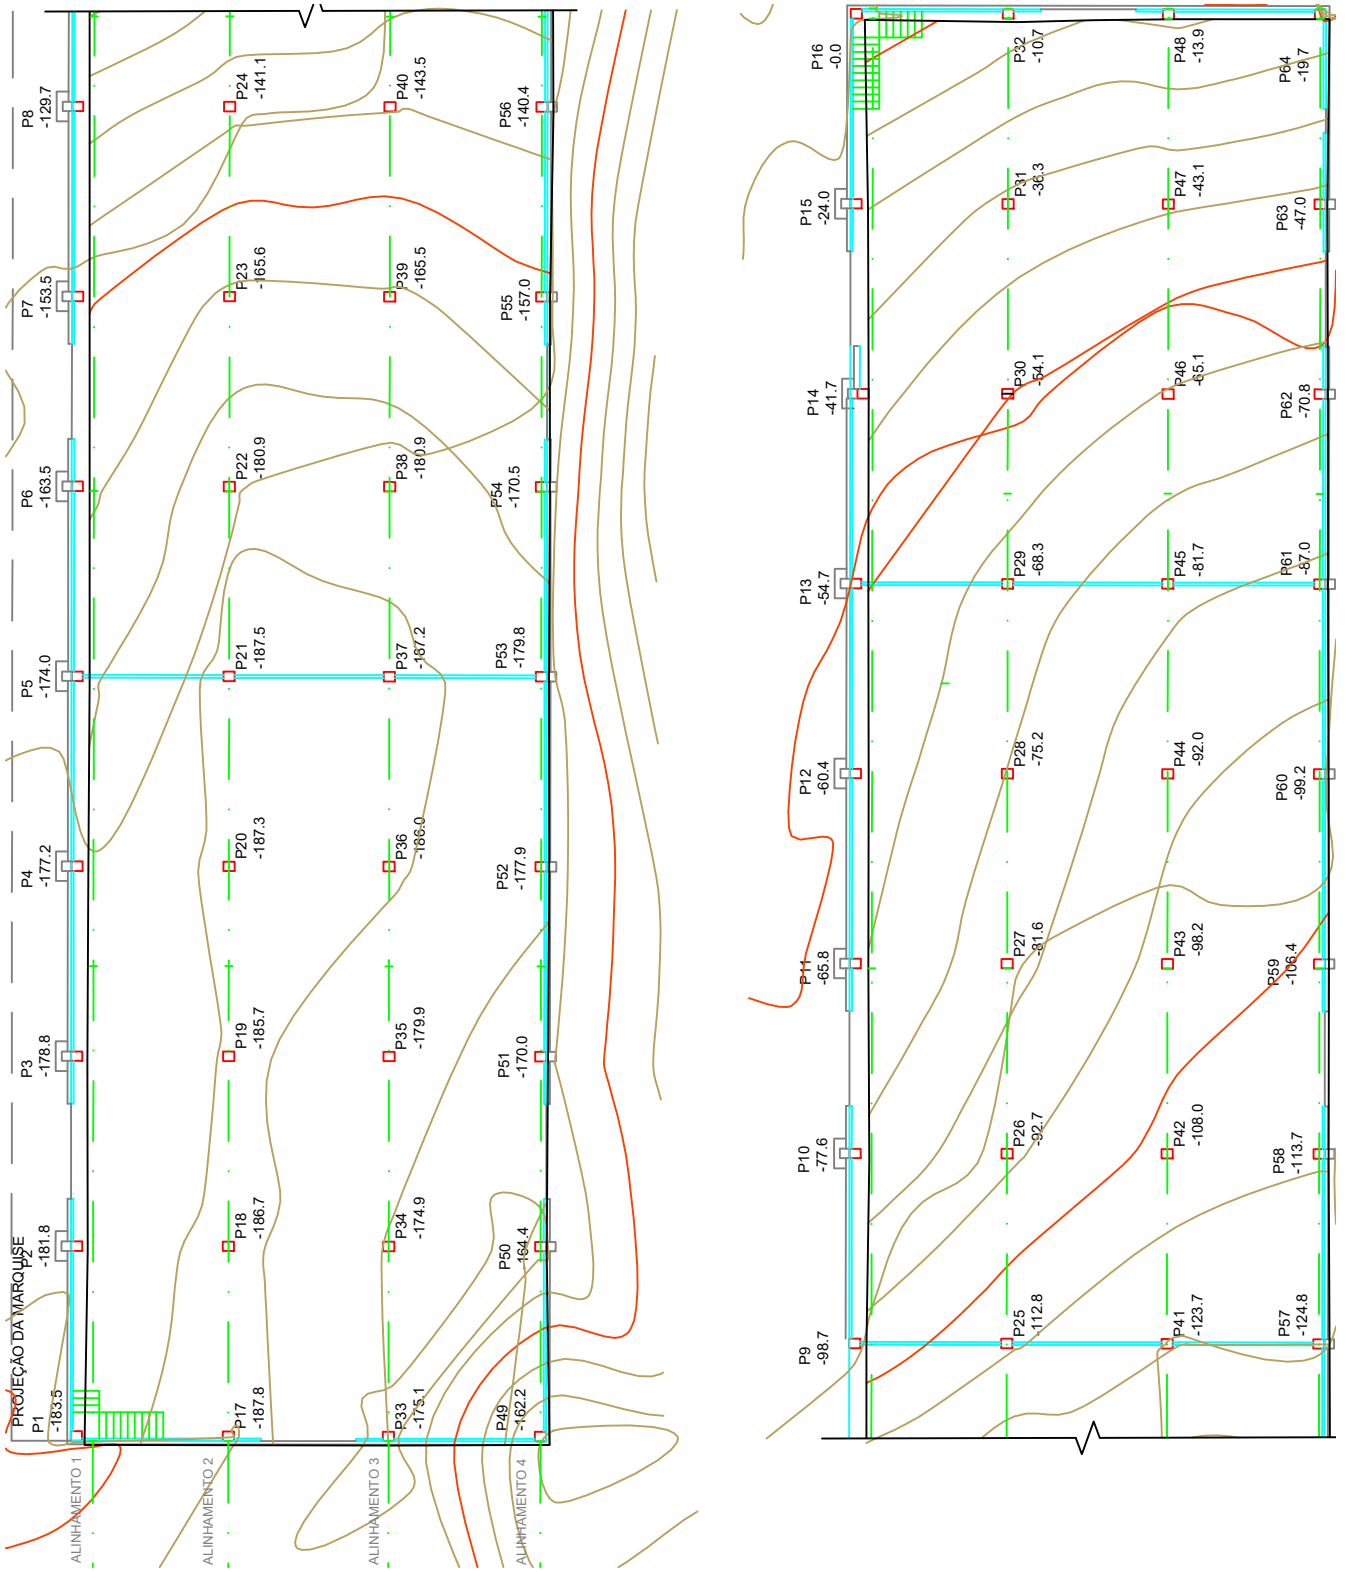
Perfil de níveis do pilar 1 ao pilar 16.
